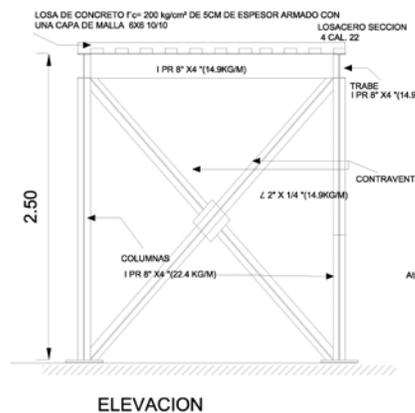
Contraventeos en estructura metálica para cubo de tinacos en el Valle de México.
